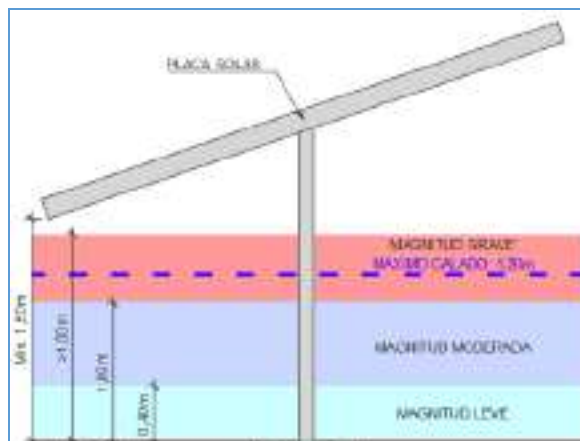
Propuesta de disposición de planta solar en la finca “Santa María de las Lomas”
